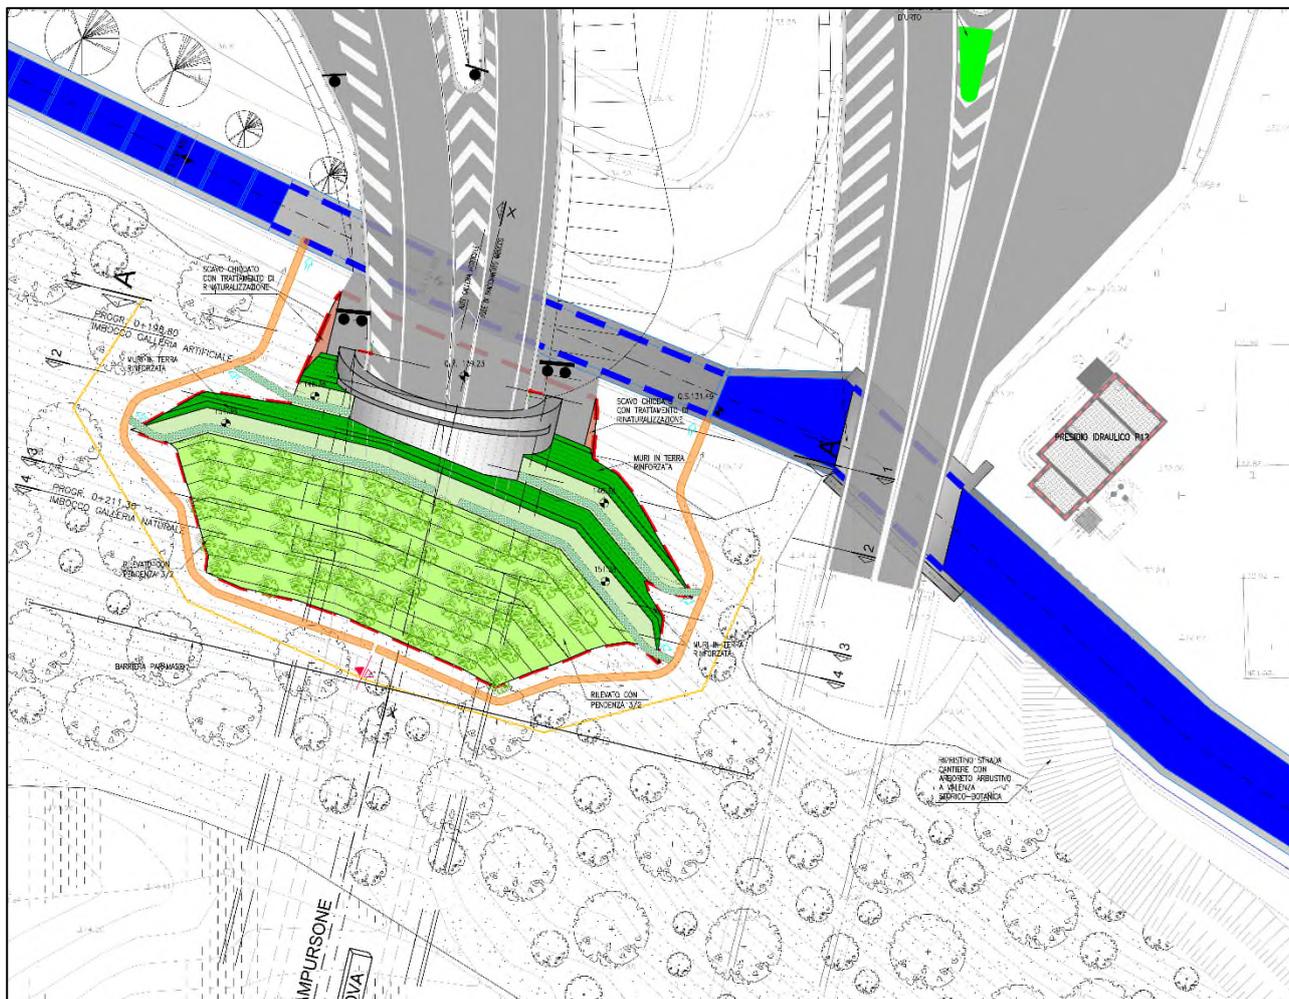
Planimetria finale Imbocco Campursone Nord (fonte: elaborato 110721-LL1B-PES6-G21-GF21N-SSF00-D-AUA8410-1)
